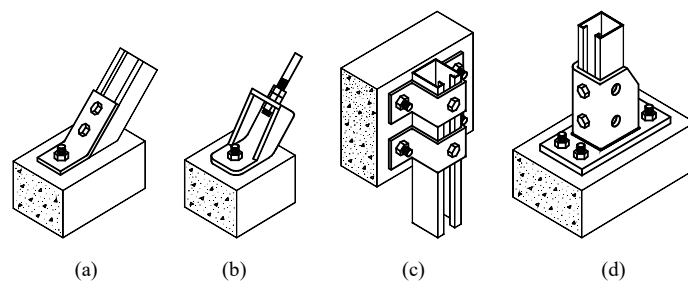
钢构件与混凝土结构之间的连接示意
